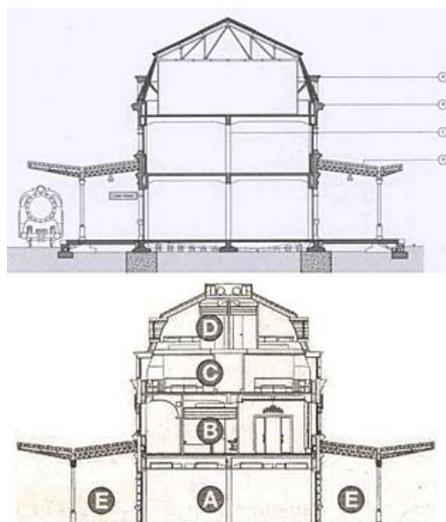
Estado original en la imagen superior (levantamiento de Ezequiel Usón) y proyecto (Pérez Latorre) en la imagen inferior.
